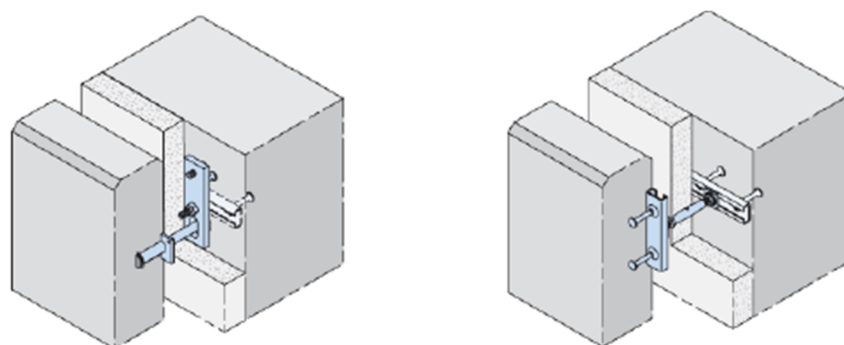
Ancoragem por cavilhas em juntas verticais e horizontais.
